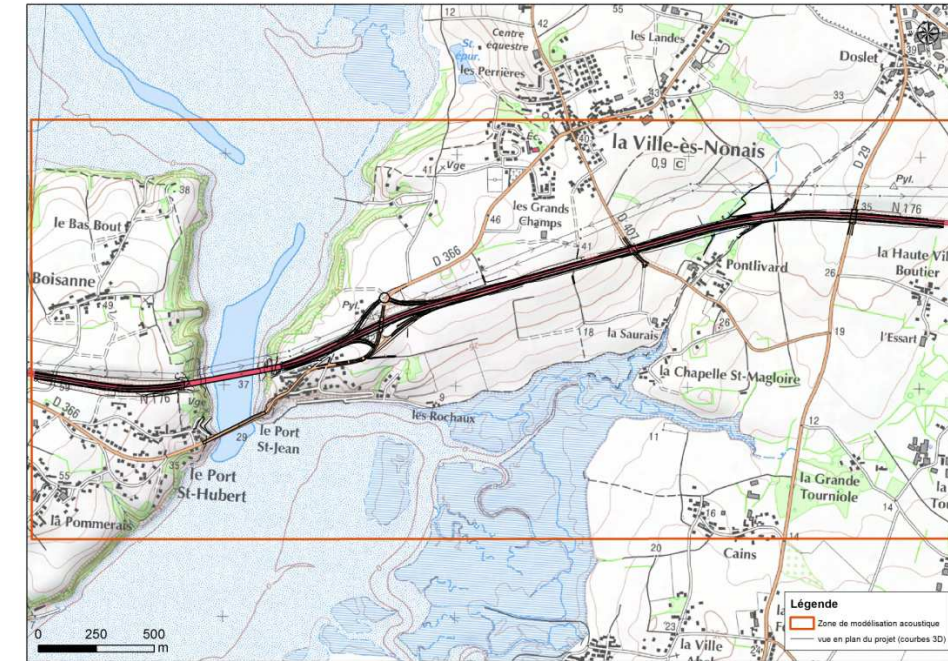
Vue en plan de la zone modélisée (source EREA – fond de plan IGN)
